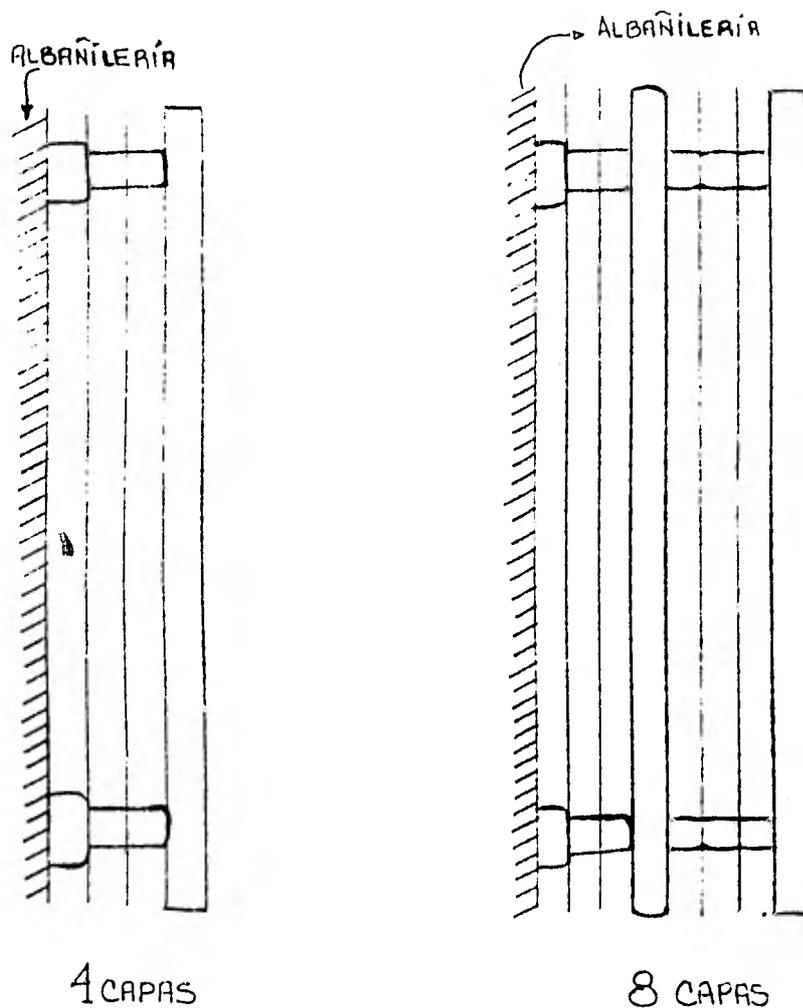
APLICACION DE AISLAMIENTO REFLECTIVO A MUROS.
